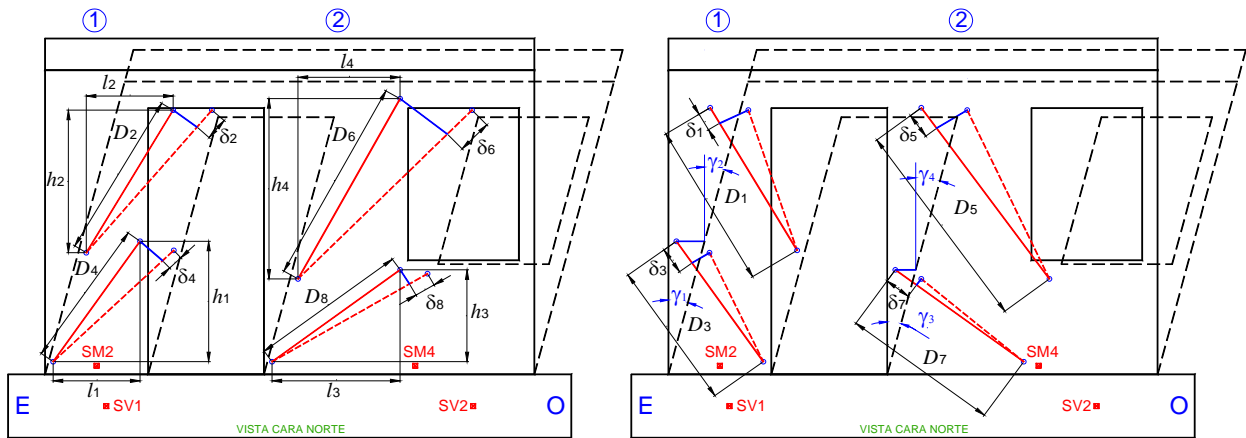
Cálculo de la deformación angular para muros con aberturas
